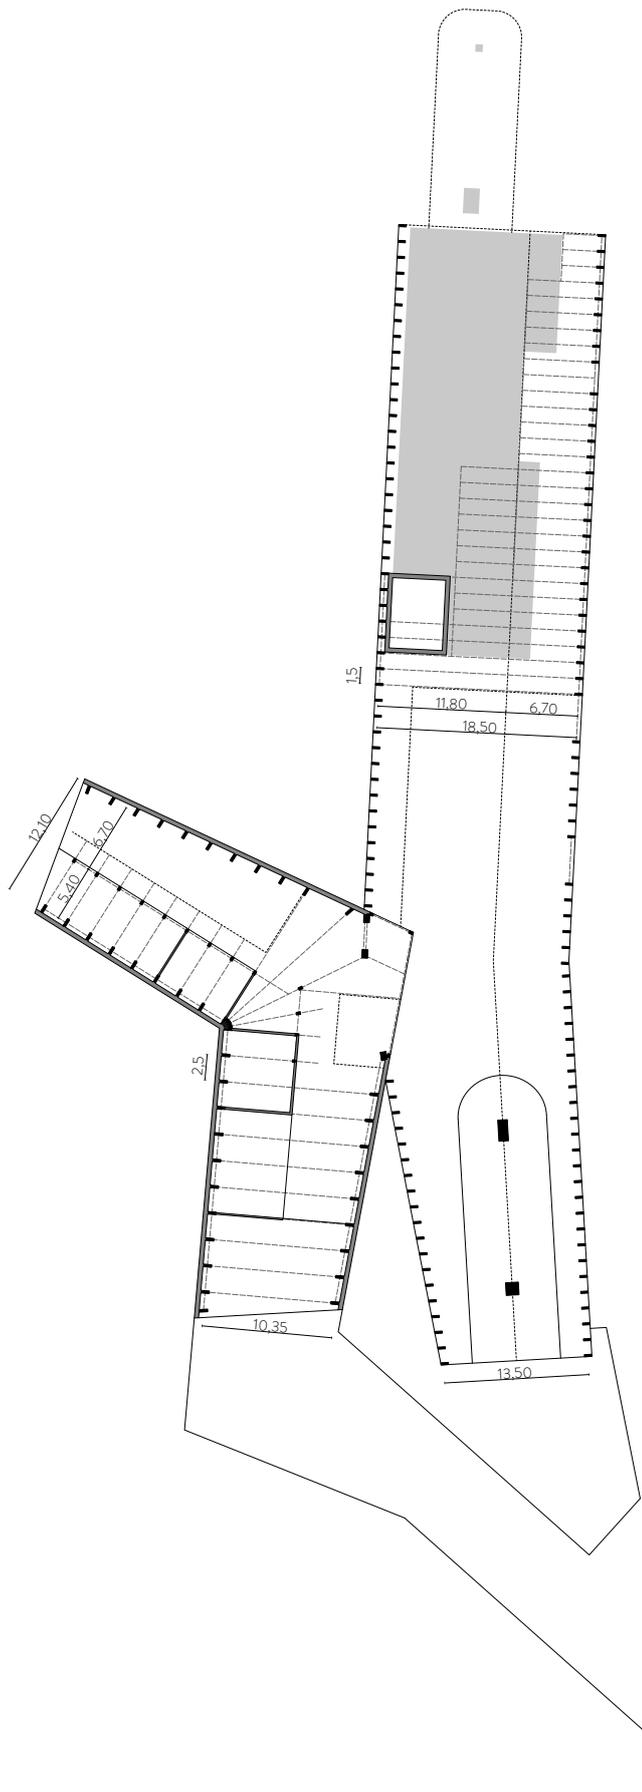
Pianta strutturale piano strada, schema a setti portanti in cemento armato.
